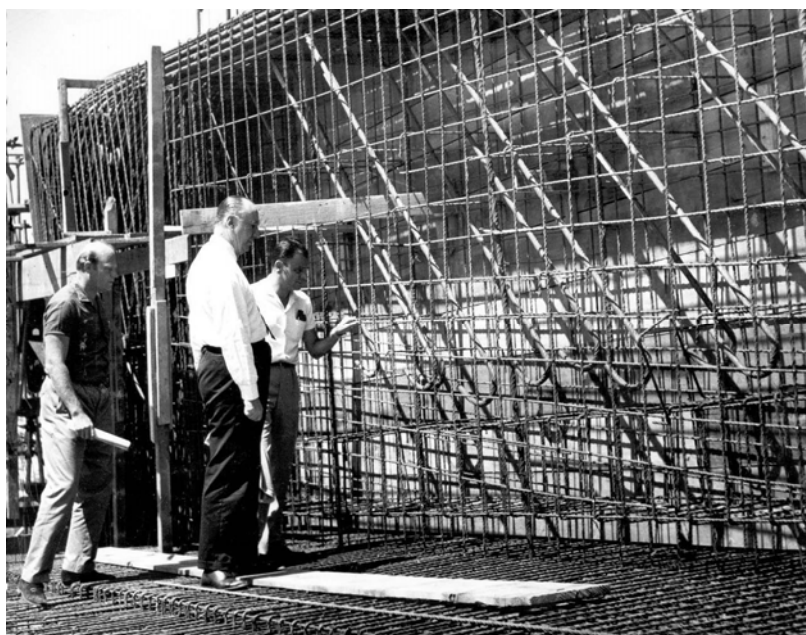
Foto da viga de cobertura na região do pilar externo. Observa-se a elevada densidade de armação na parte superior
